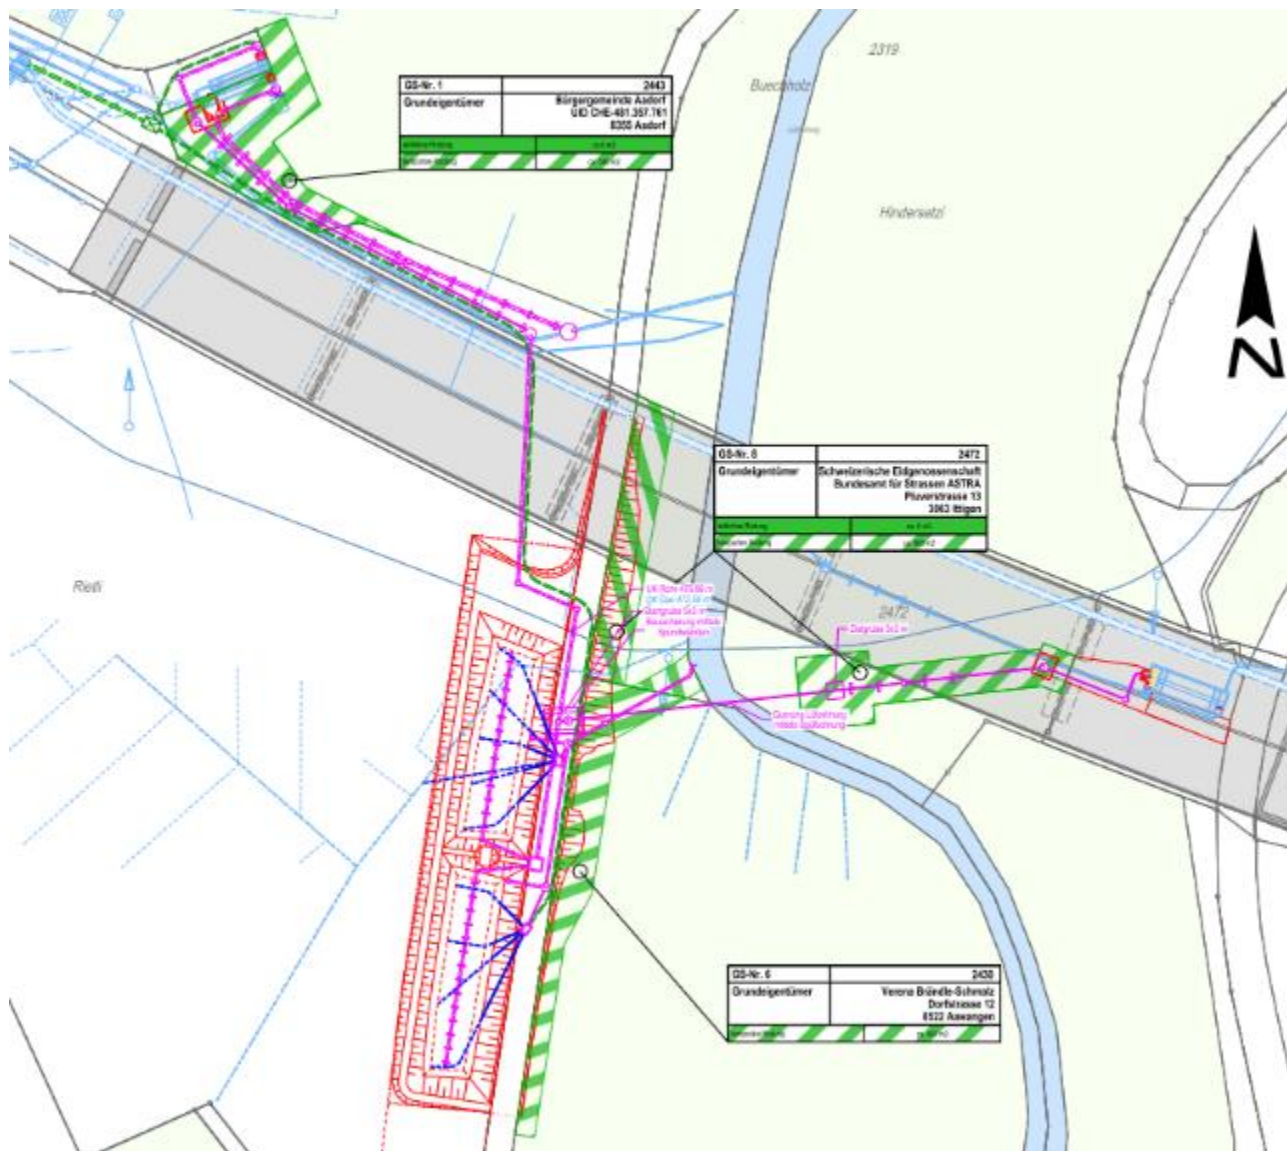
Ausschnitt aus dem Rodungsplan mit den eingezeichneten, tangierten Waldflächen
